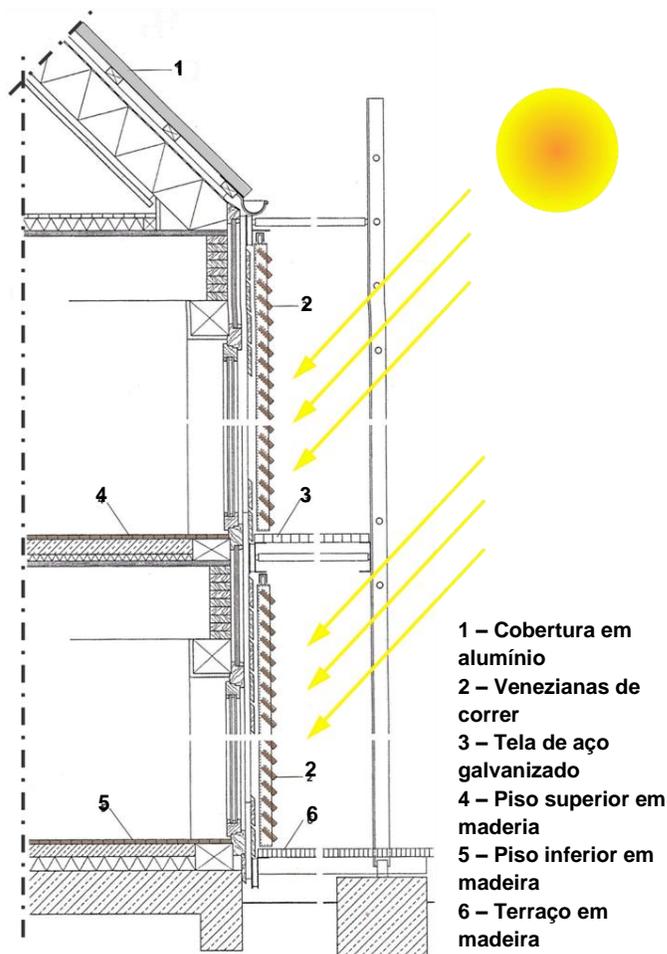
Corte em detalhe – Fachada Oeste.
